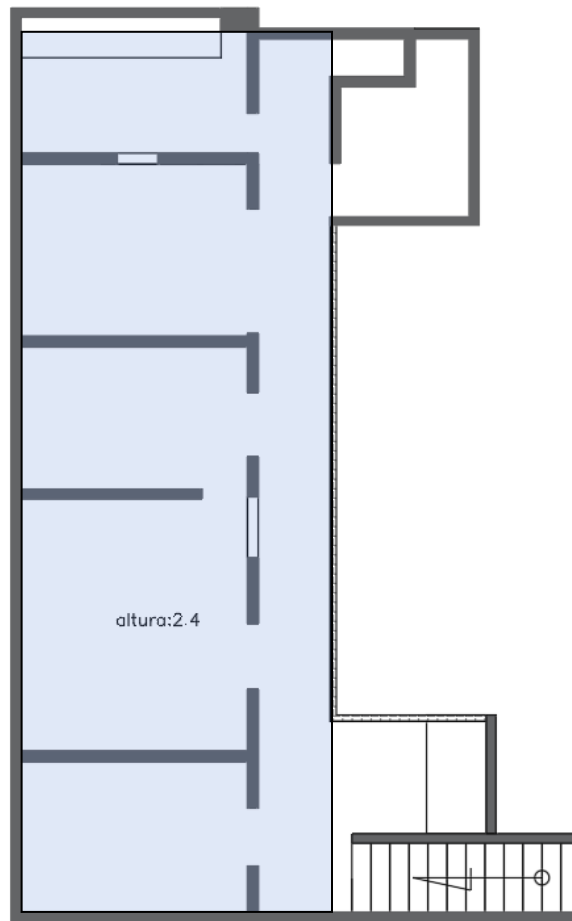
Primera planta antigua. Fuente: Elaboracion propia.
